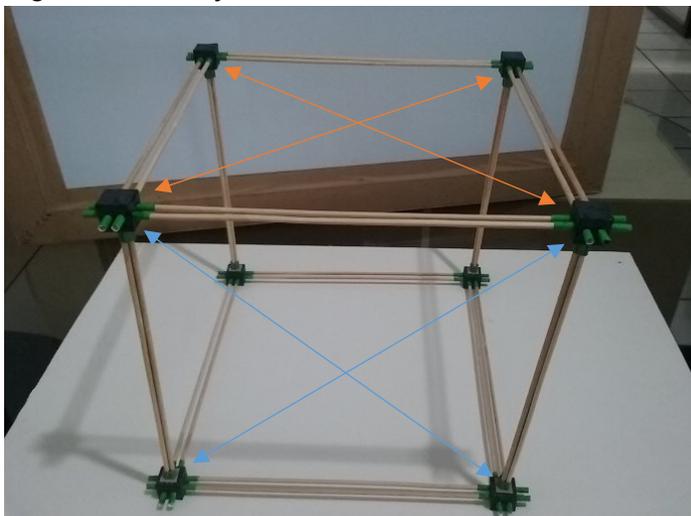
Conjunto estrutural: vigas, pilares e ligações.
